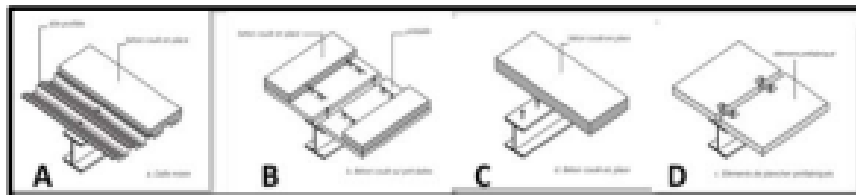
Types de dalles pour les poutres mixtes<sup>100</sup>
